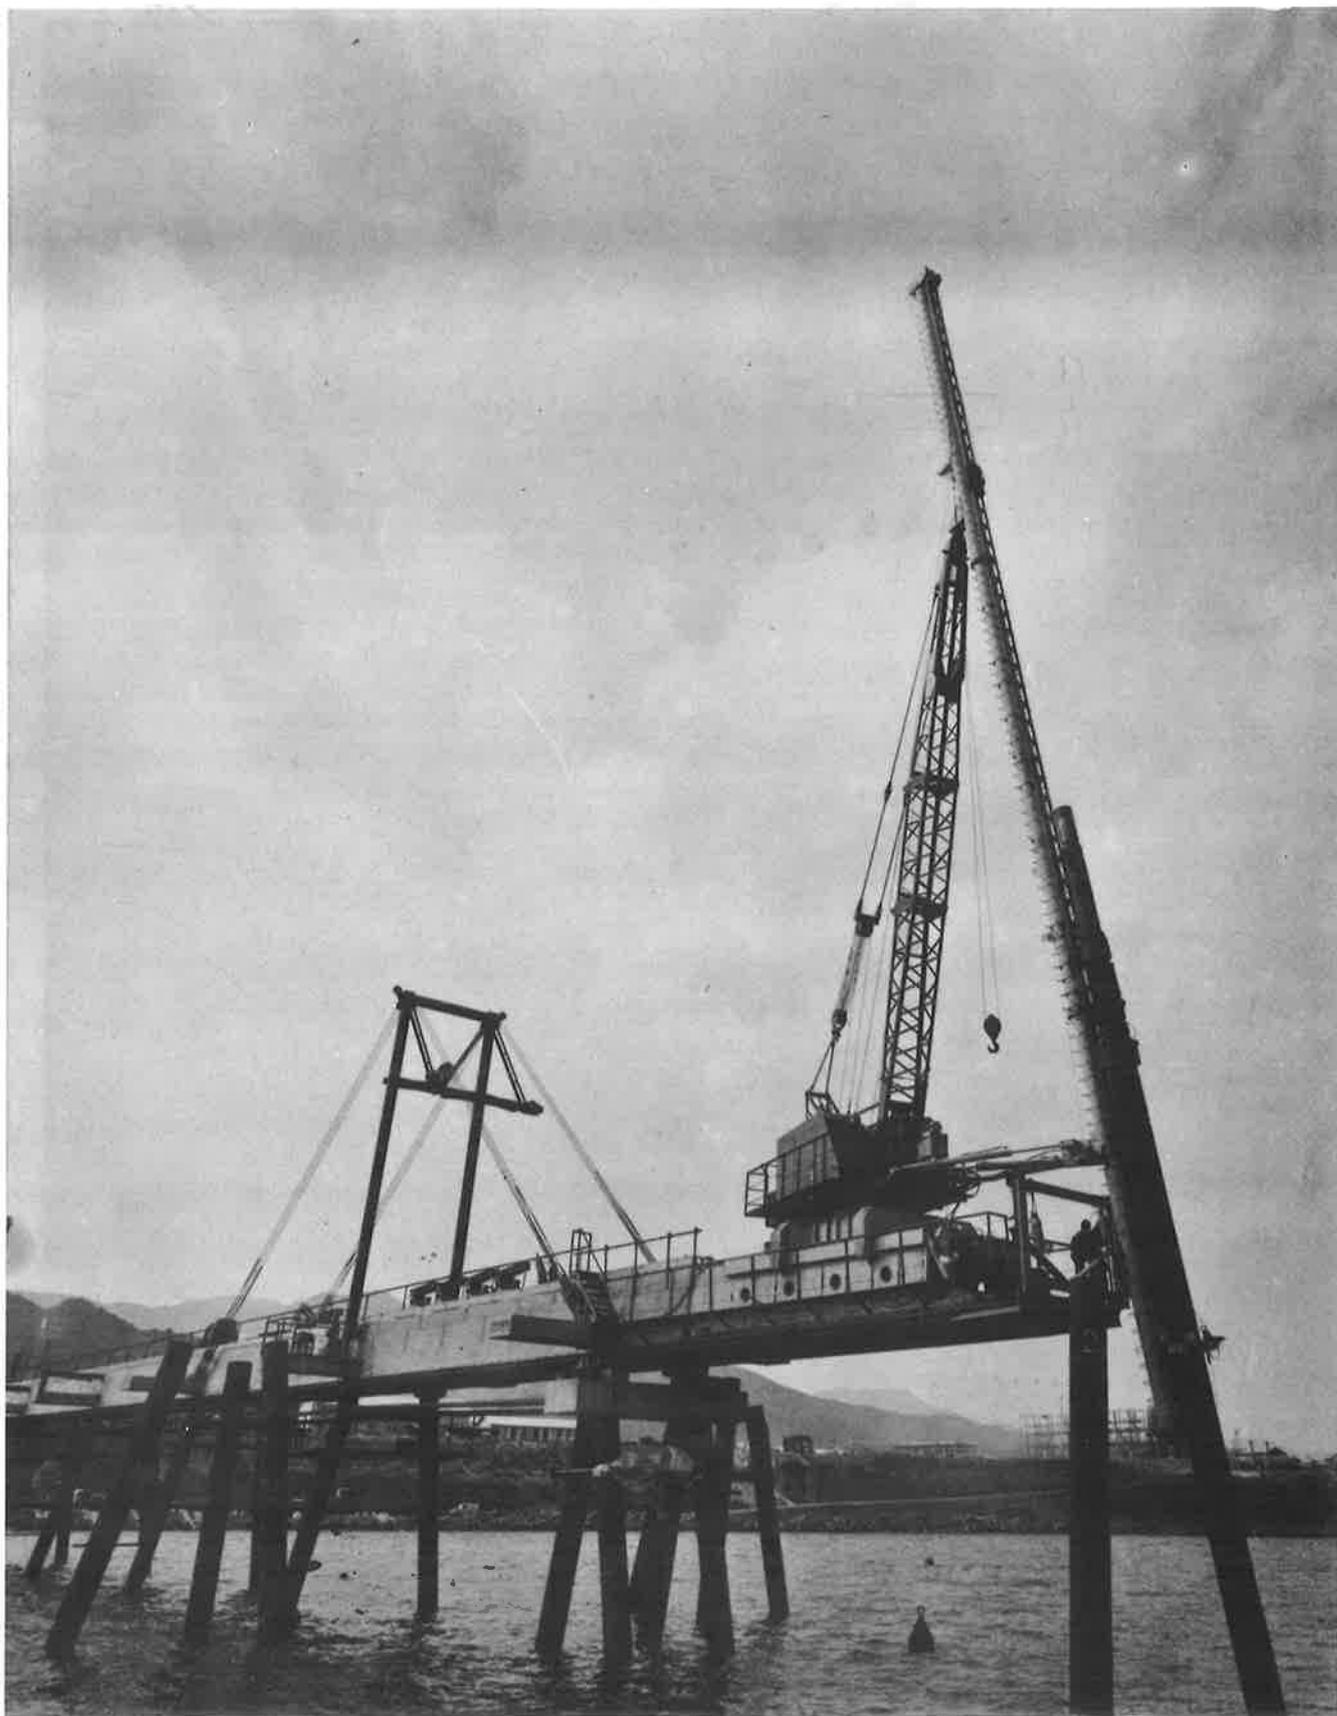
Pontile SARAS - Il battipalo in funzione sull'avam-
